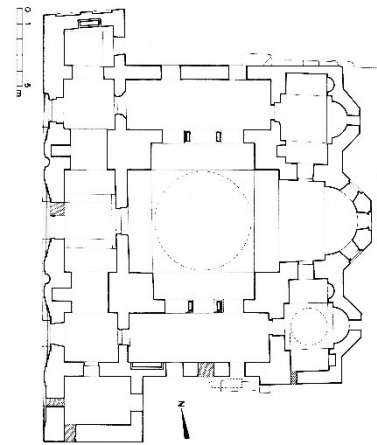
Grundriss der Koimesiskirche von Nikaia
